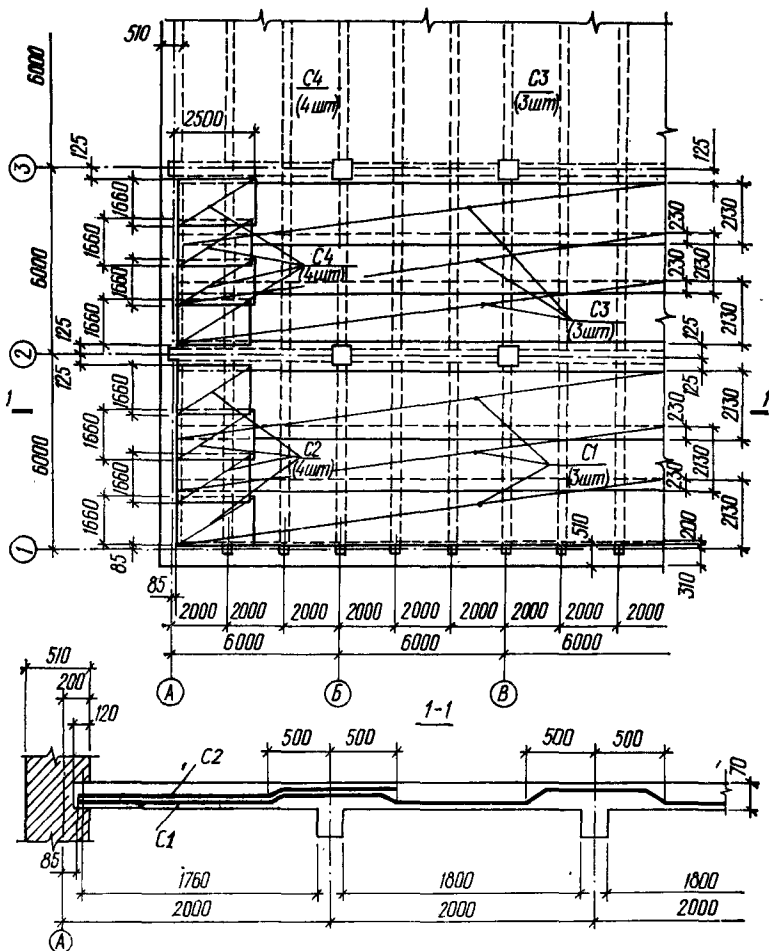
Армирование плиты сварными рулонными сетками с продольной рабочей арматурой:
